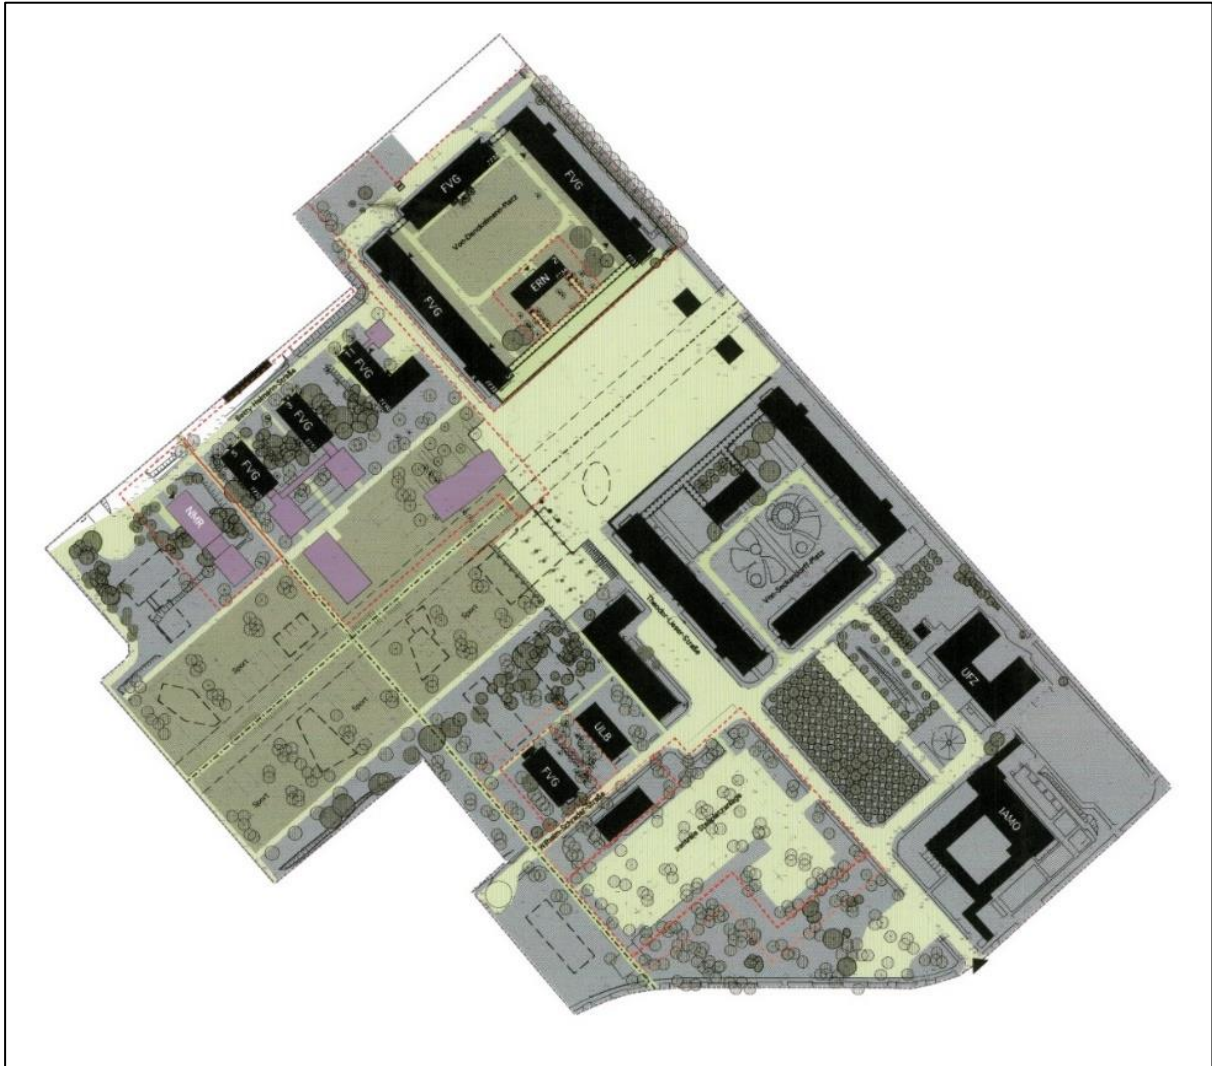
Masterplan des Landesbetriebs Bau vom 1.8.2005 Plan Nr. 0506-VE 10
